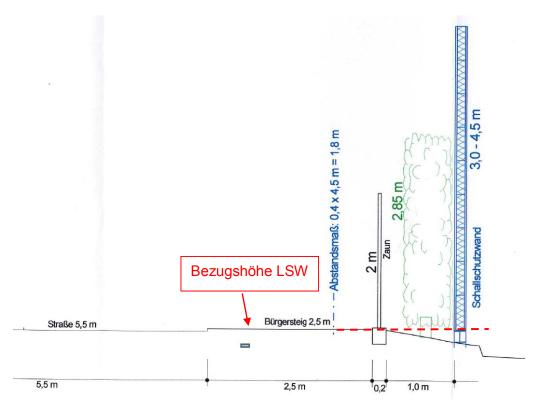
Betriebsflächenplan Autoverwertung und Schrottplatz Matthias Mayer, Plan-Nr.: Lärmschutzwand: Ingenieurbüro für Umweltschutz und Energie, Breite Straße 34, 56626 Andernach, (rote Eintragungen nachträglich durch das Büro ISU)
